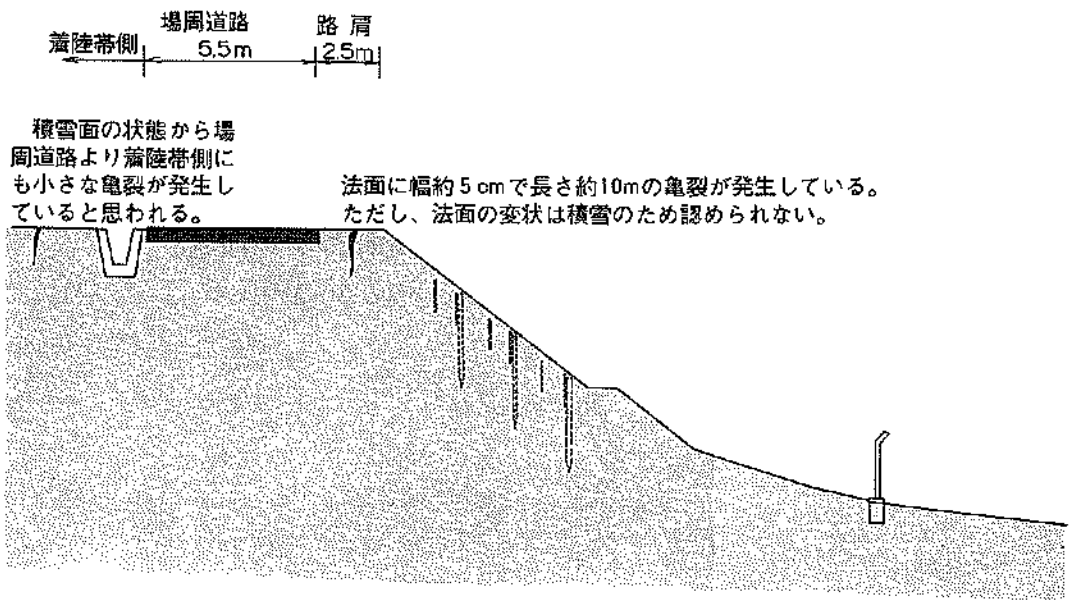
釧路空港場周道路の被災状況断面図 (D-D断面)
